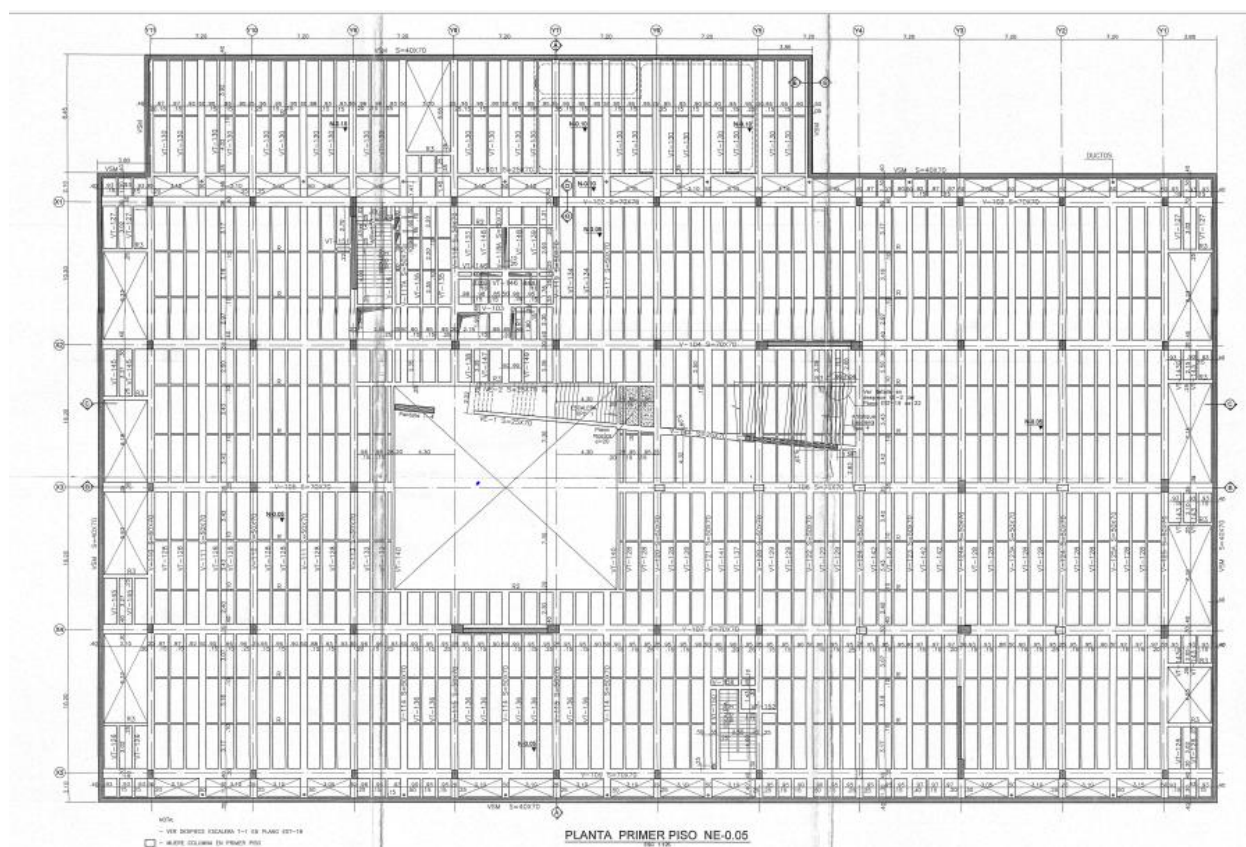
Planta primer piso (viga sobre muro en gris oscuro). Fuente: Diseños estructurales.
